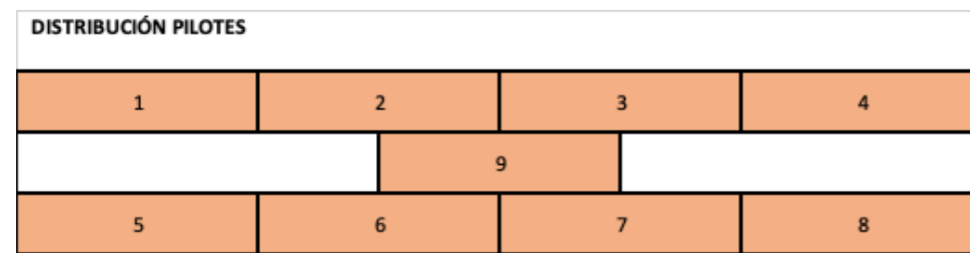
Croquis de la distribución de pilotes en planta. Fuente: Elaboración propia.
